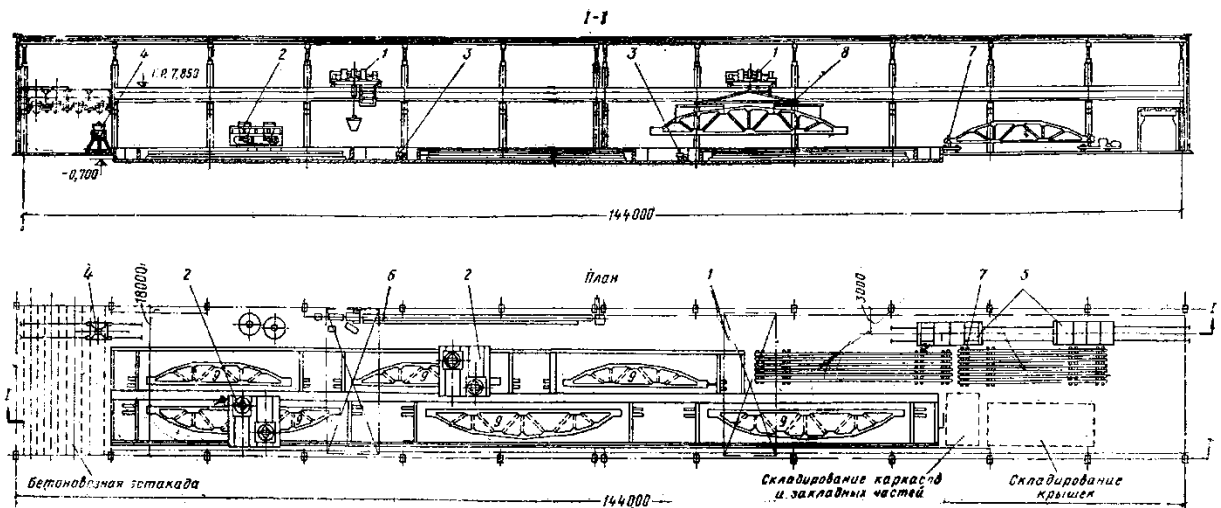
Вариант линии коротких пакетных стенов со стенд-камерами для изготовления раскосных ферм пролетом 18 и 24м (продольный разрез и план):
